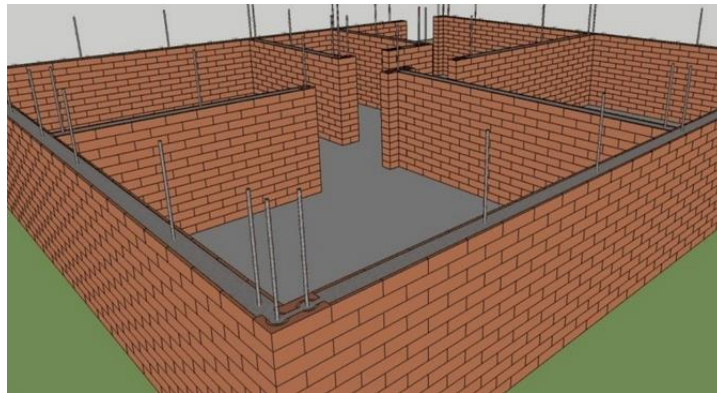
Ejemplo viguetas a 0,90m, sistema constructivo Siconte
